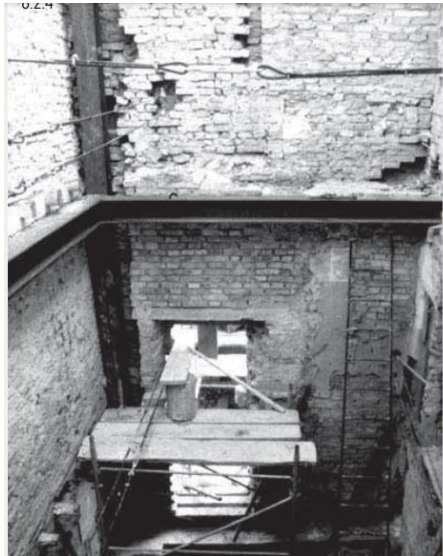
Plantas de diseño de restauración. Conservación de mampostería. Fuente propia
